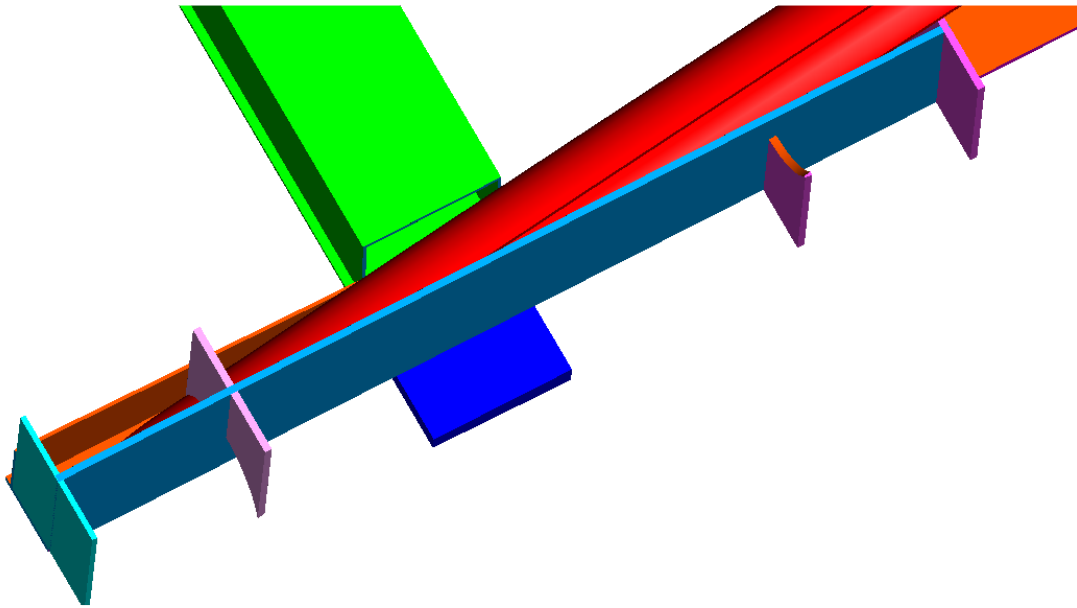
Detalle rigidizadores en la unión arco con viga cajón
